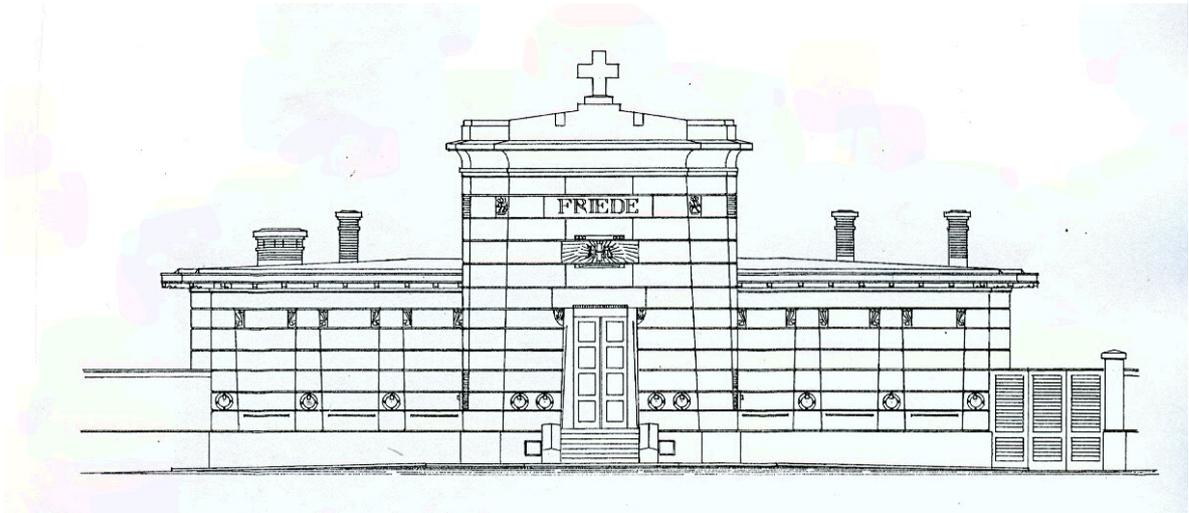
FASSADENPLAN AUFBAHRUNGSKAPELLE
